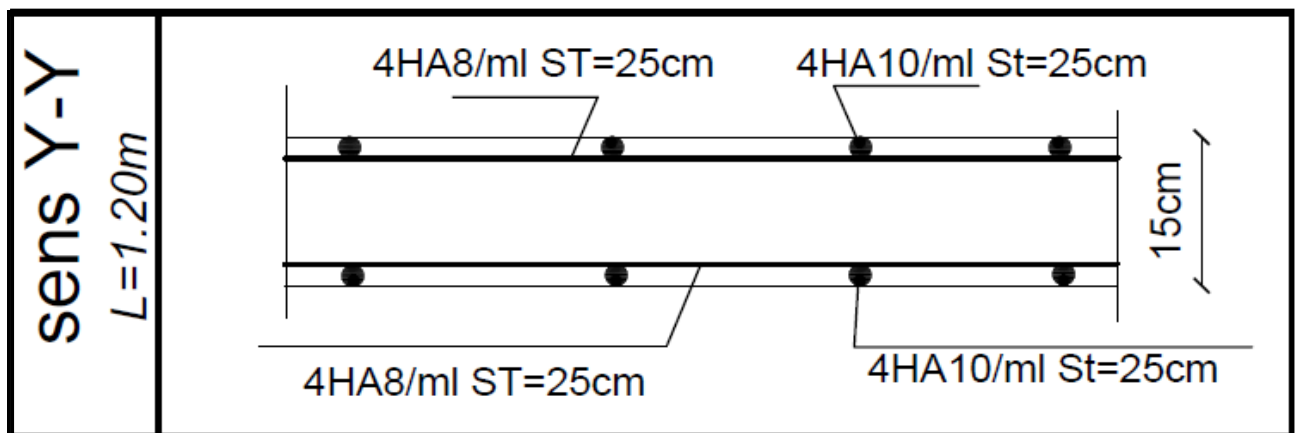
plan de ferrailage de la salle machine suivant y-y
